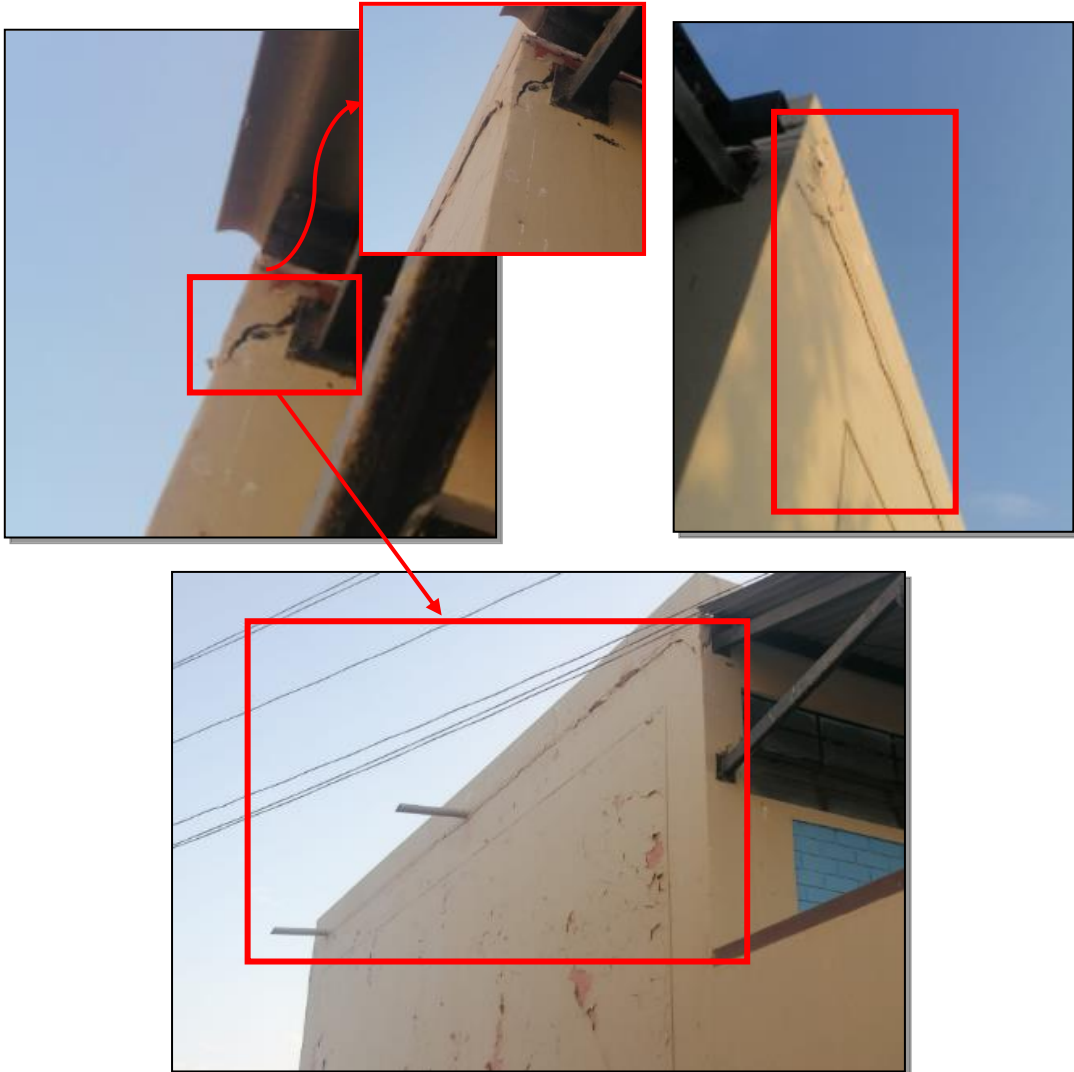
Vista de perfil del Agrietamiento de losa– Segundo Nivel
